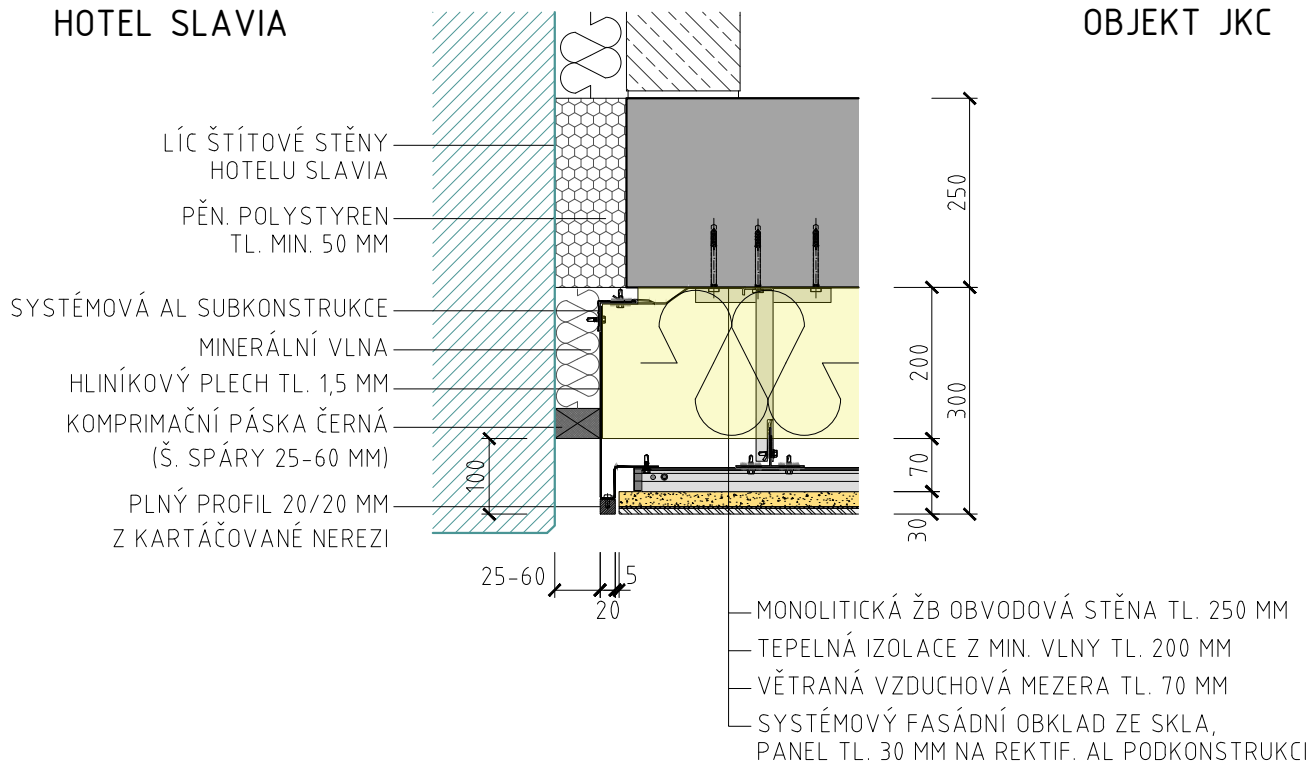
DETAILY STAV. NAPOJENÍ K SOUSEDNÍM OBJEKTŮM
